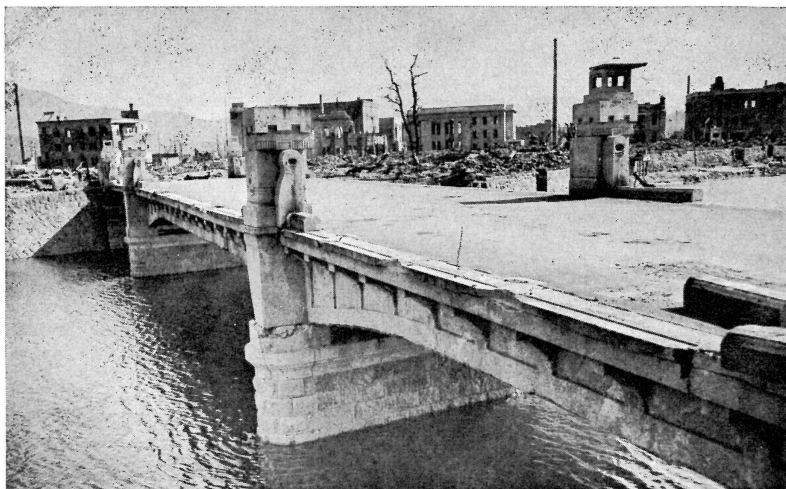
a Brücke mit Stahlbetonfahrbahndecke auf Stahlträgern; der äußere Träger hatte eine Betonverkleidung (etwa 80 m vom Nullpunkt in Hiroshima). Das Brückengeländer war weggedrückt worden, aber die Fahrbahn wurde nur wenig beschädigt, so daß der Verkehr weitergehen konnte.
